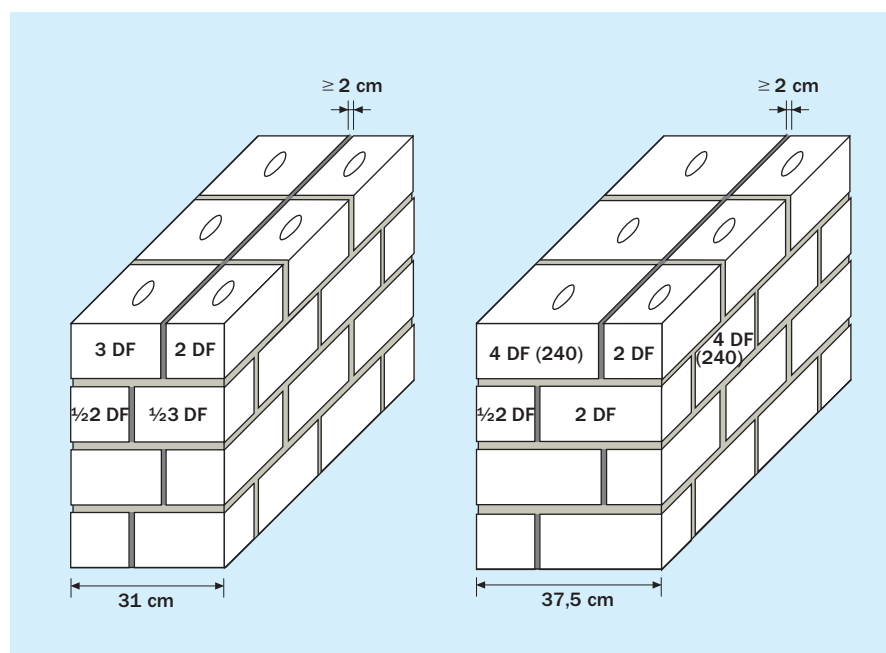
KS-Mauerwerk ohne Wärmedämmung als Sichtmauerwerk
